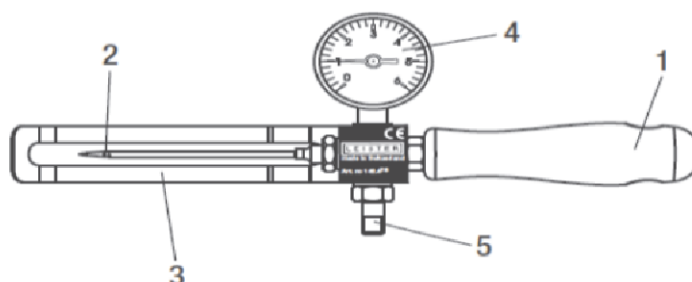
Приспособление для проверки двойного шва с иглой. 1- ручки прибора; 2- тестовая игла для нагнетания сжатого воздуха; 3- защитная скоба металла для правильного позиционирования тестовой иглы; 4- манометр; 5- штуцер для подключения компрессора.
